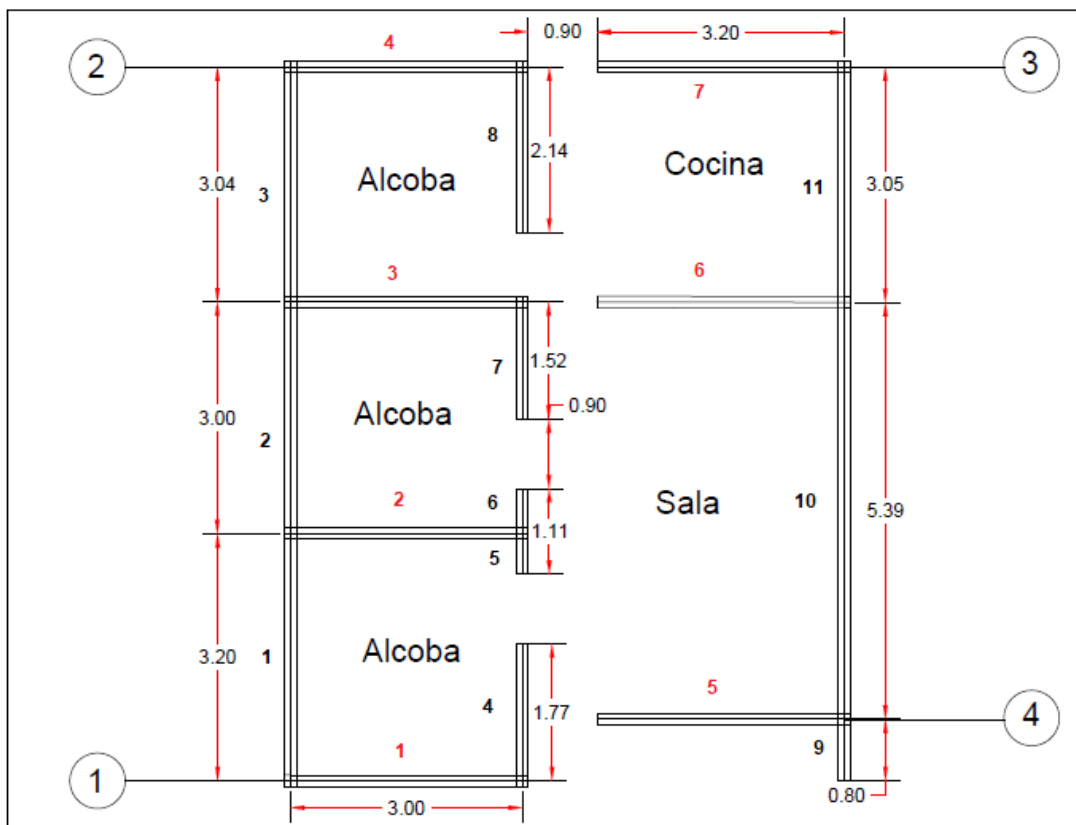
Dibujo en planta de vivienda tipo 1 (Fuente: Elaboración propia)
